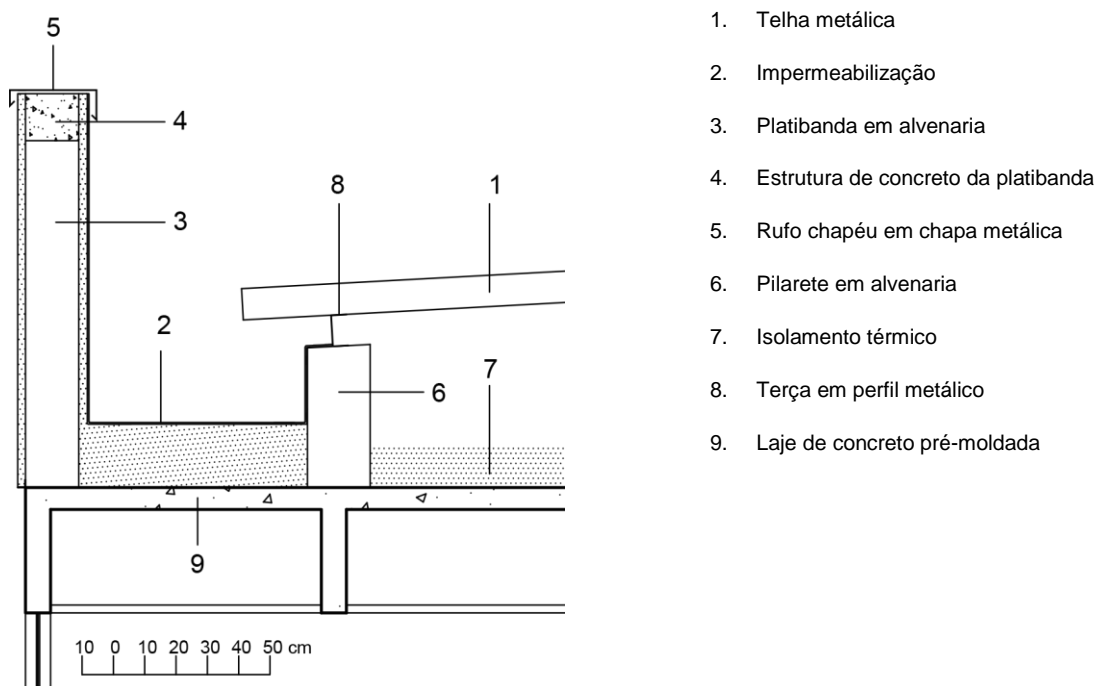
Detalhe da calha impermeabilizada e platibanda em alvenaria (Fonte: SEF)
